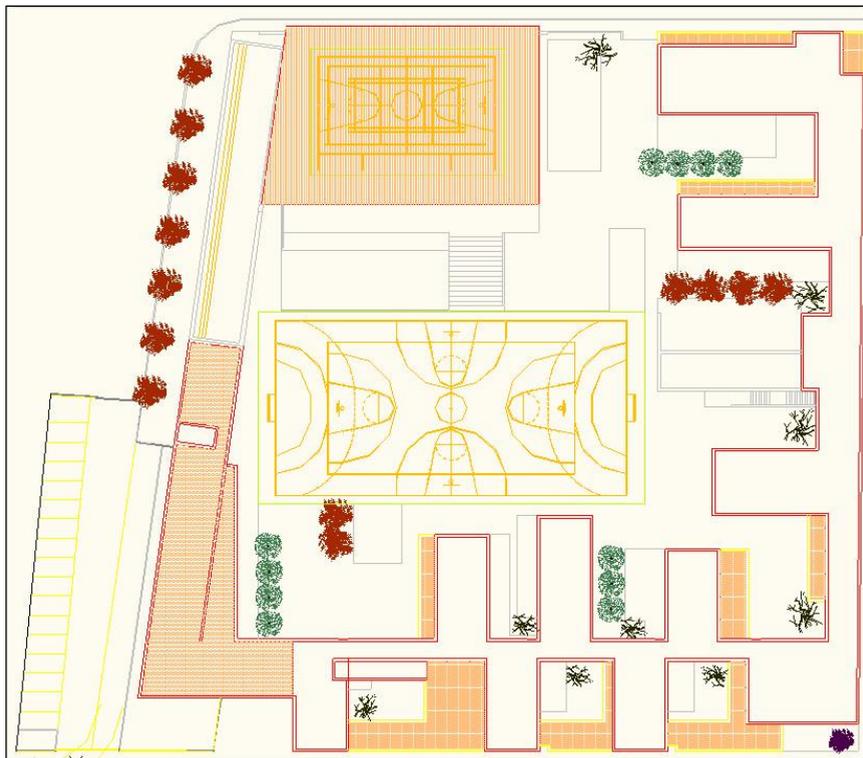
Planta general, Año 2005, Fuente proyecto de Ejecución
